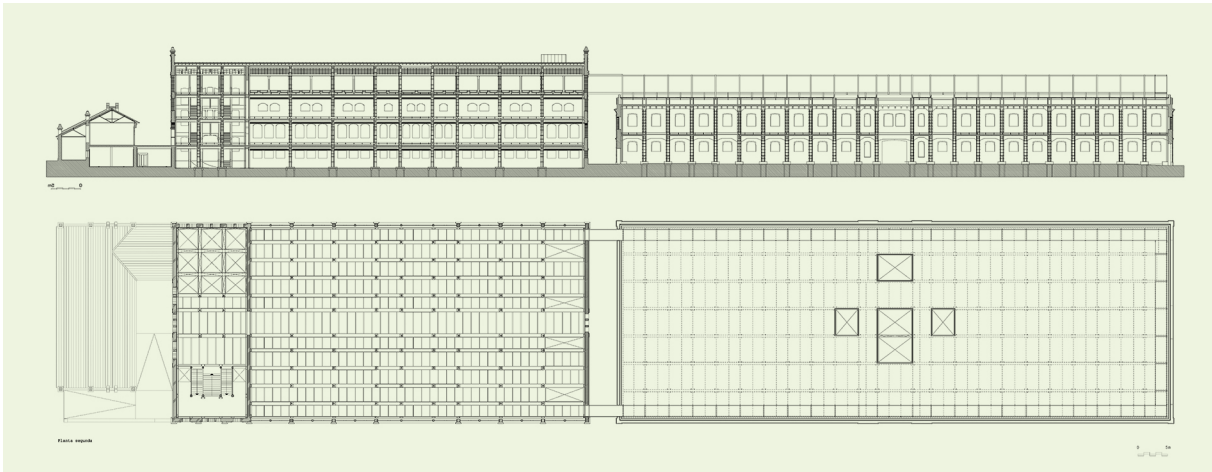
Planta y sección longitudinal de las naves 8 y 9. [Fuente: del autor, Arturo Franco]
